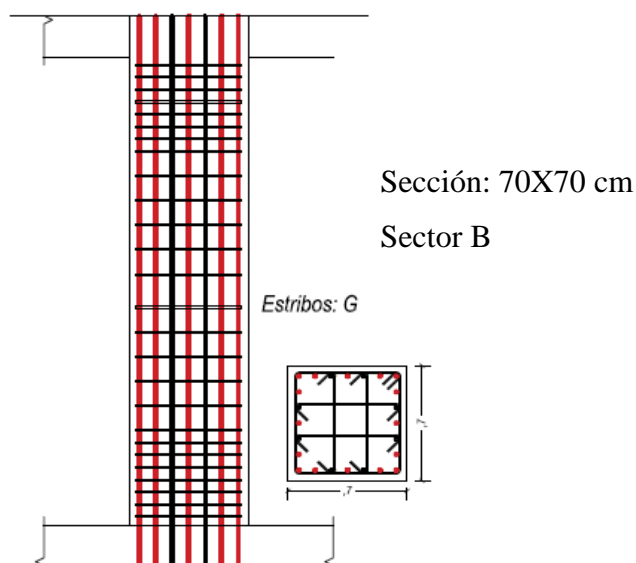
Detalle de Columna en Base Aislada (B)
